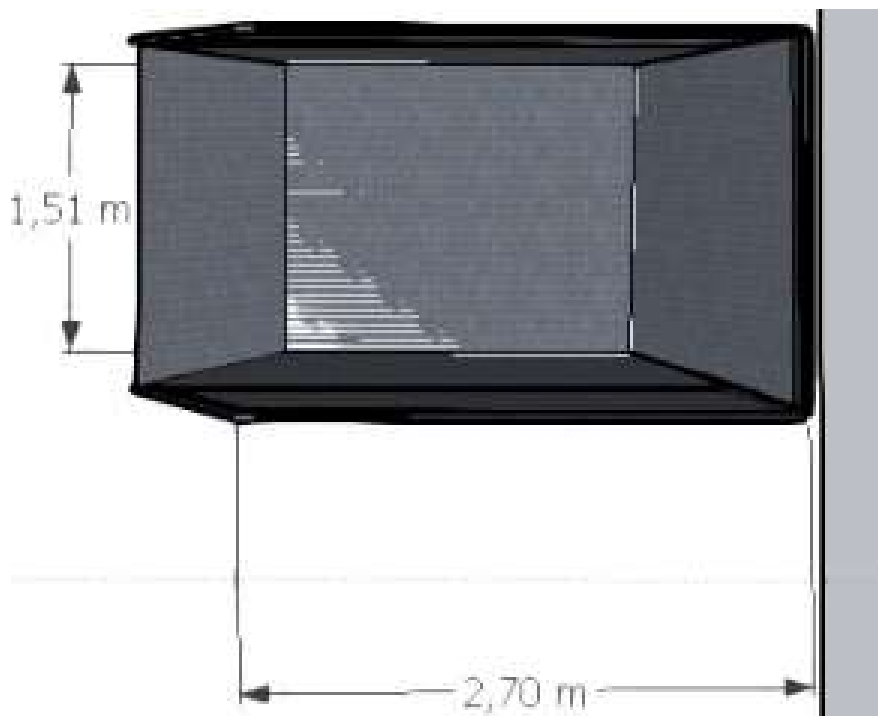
Área para recepção de Resíduos da Construção Civil.
